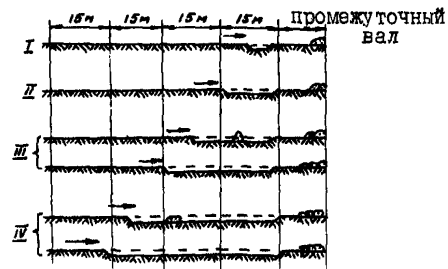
Схема разработки выемки с перемещением грунта и укладкой в насыпь бульдозерами
